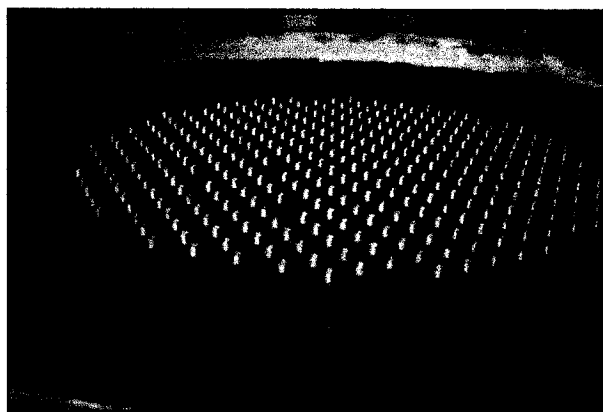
Essai sur modèle réduit d'une fondation en sol renforcé.
